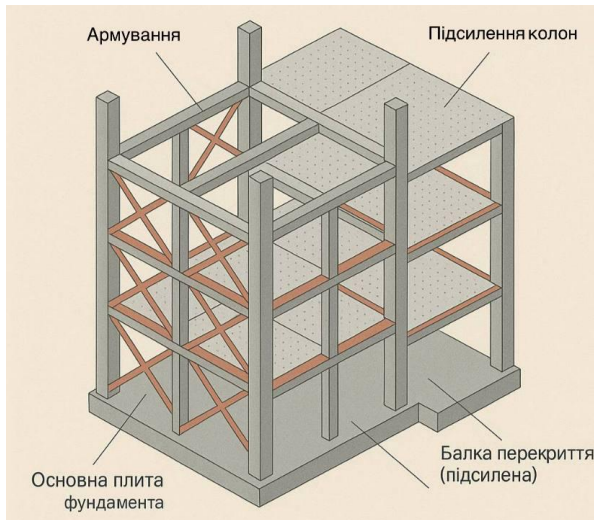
Конструктивна схема армованого каркасу реконструйованої будівлі
